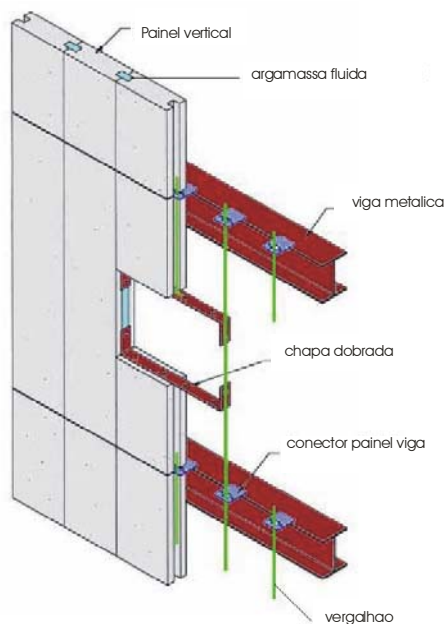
Esquema de fixação de painel autoclavado (KRÜGER, 2000).
